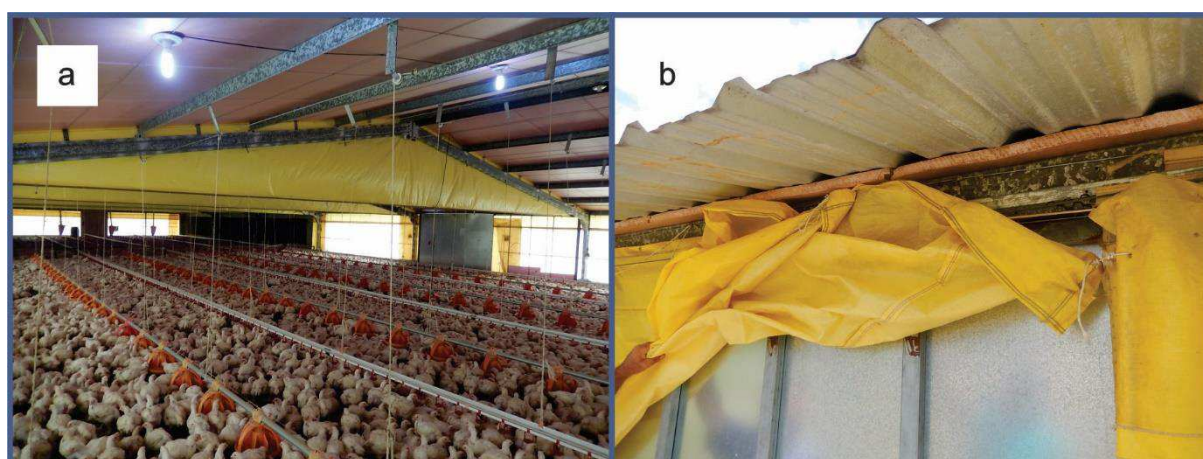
Detalhes da cobertura com aletas (a) e da cobertura em telha metálica com forro em placas de poliuretano (b)
